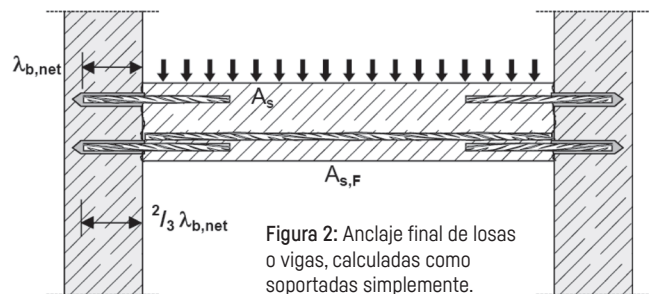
Anclaje final de losas o vigas, calculadas como soportadas simplemente.
